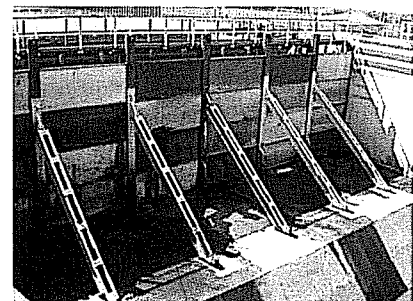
Batardeau à poutrelles soutenues par des béquilles (Magdeburg)
